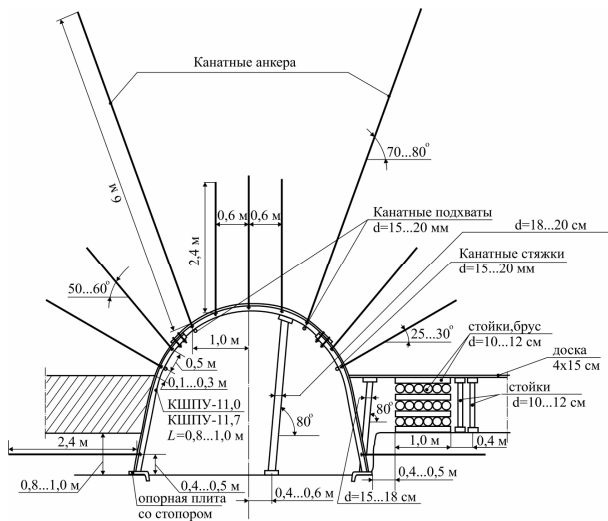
Схема поддержания выработки при возведении охранной системы из лесоматериалов
